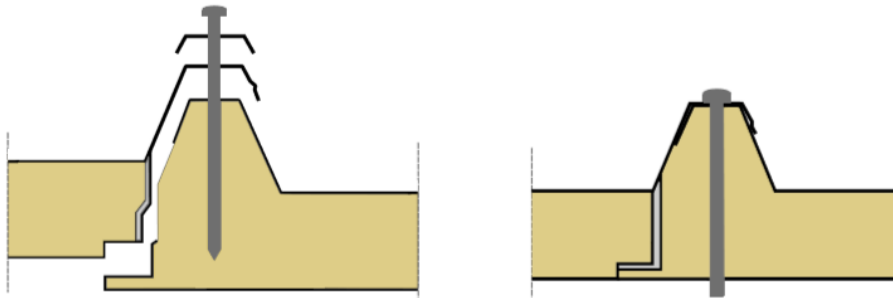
Montaje de los paneles Sandwich en la cubierta
